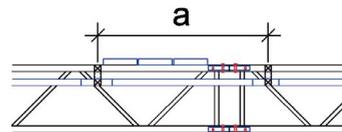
Regelausführung von Hängegerüsten mit Stahlrohr-Gitterträgern, Bauhöhe 450 mm
